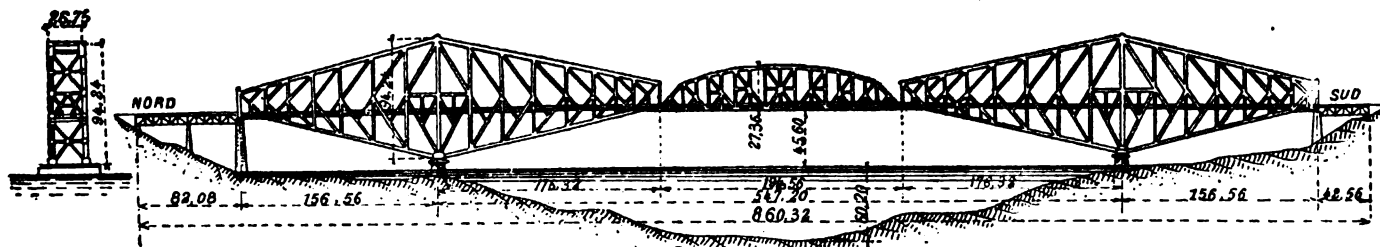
Nuovo ponte sul S. Lorenzo a Quebec. - Elevazione e sezione.
